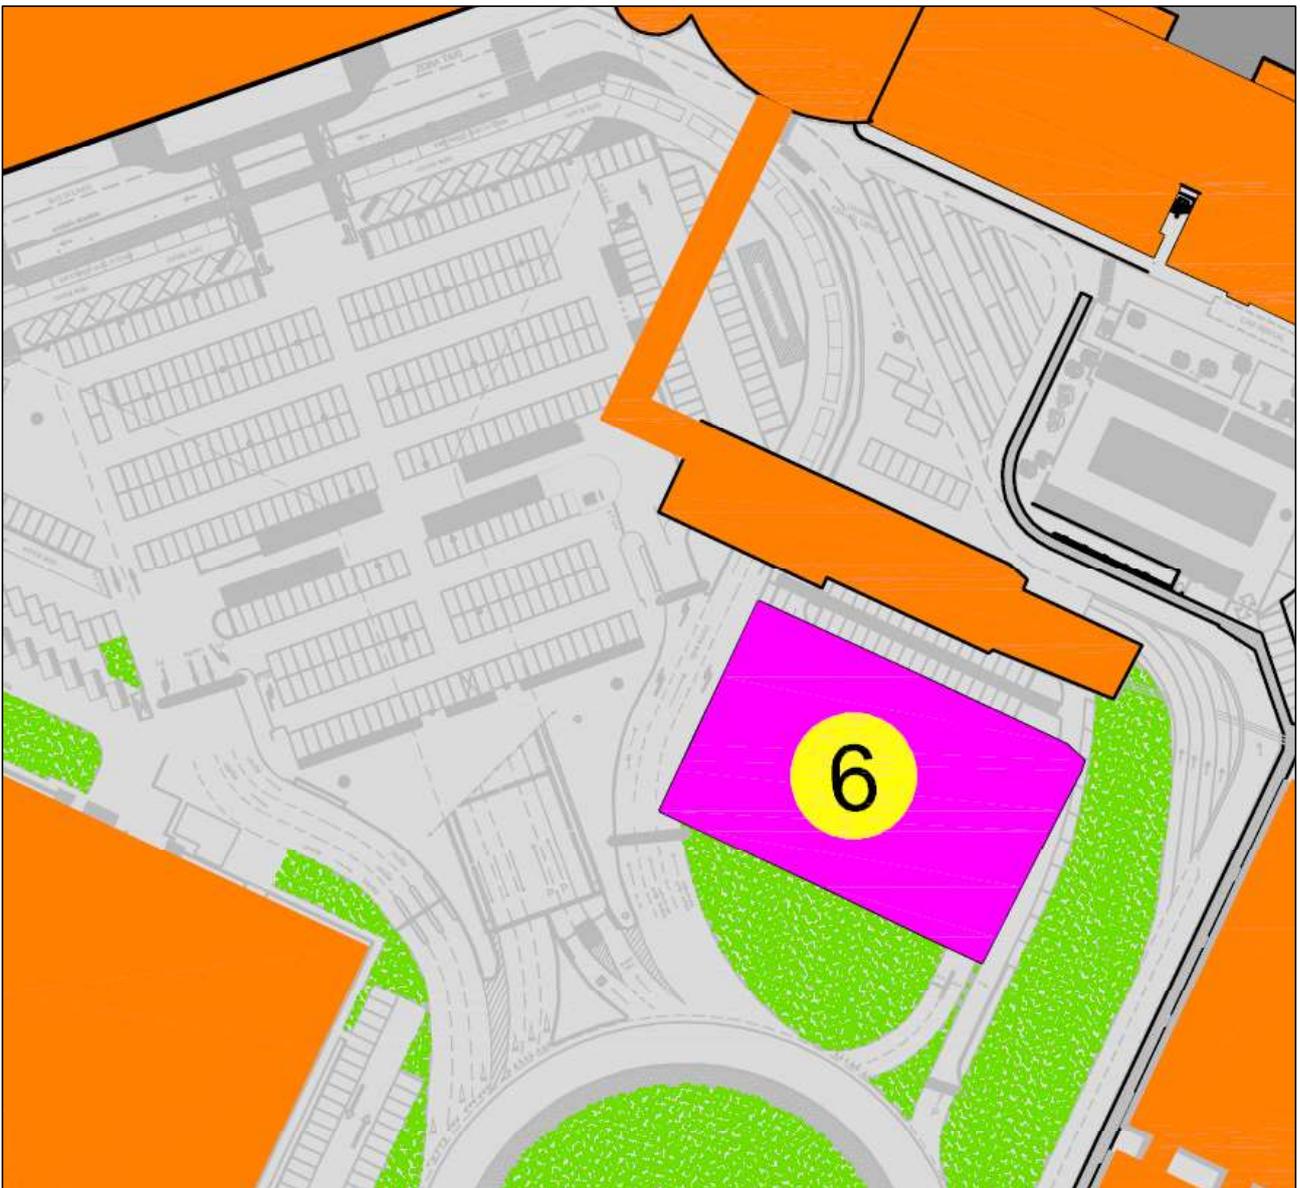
Estratto Master Plan – Intervento di sopraelevazione del Park Express
